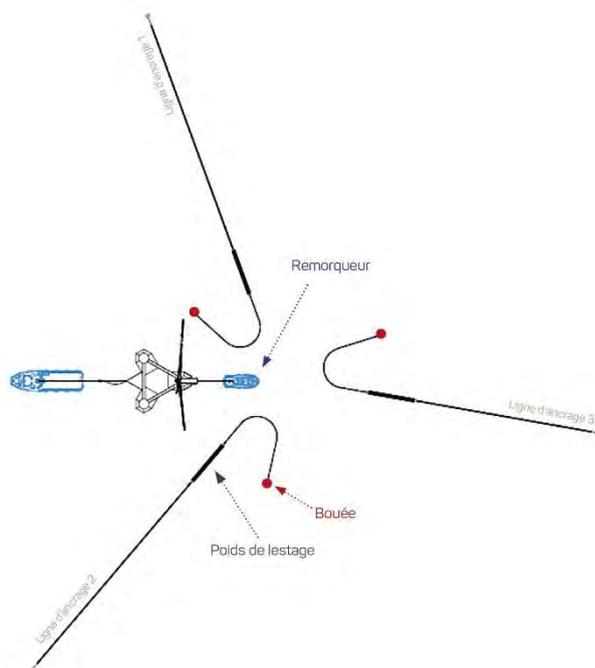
Mise en place d'une unité pour connexion au système d'ancrage (Source : EIFFAGE, PPI)
